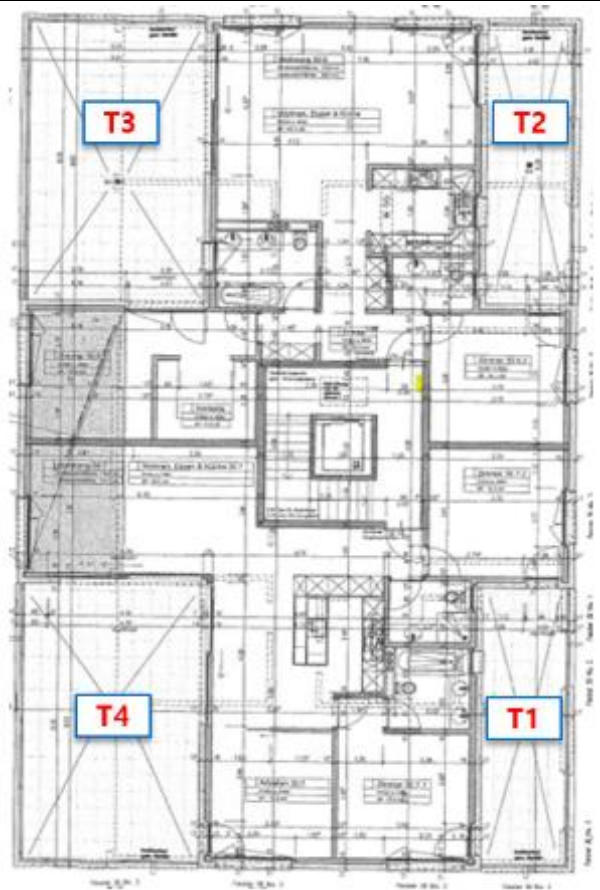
Haus 30 Dachgeschoss | Übersicht
